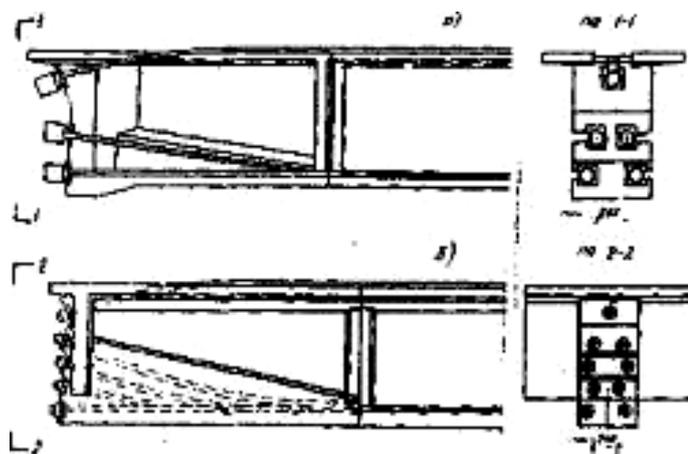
Армирование торцовых блоков члененных балок: а/ - пучками с анкерными креплениями ЦНИИС МТС; б/ - пучками с конусными анкерными креплениями.
